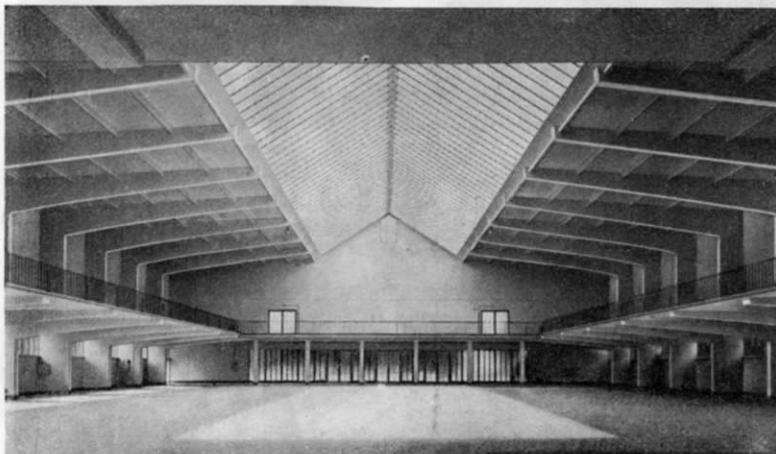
Esposizione di Monaco: interno del Salone IV.
